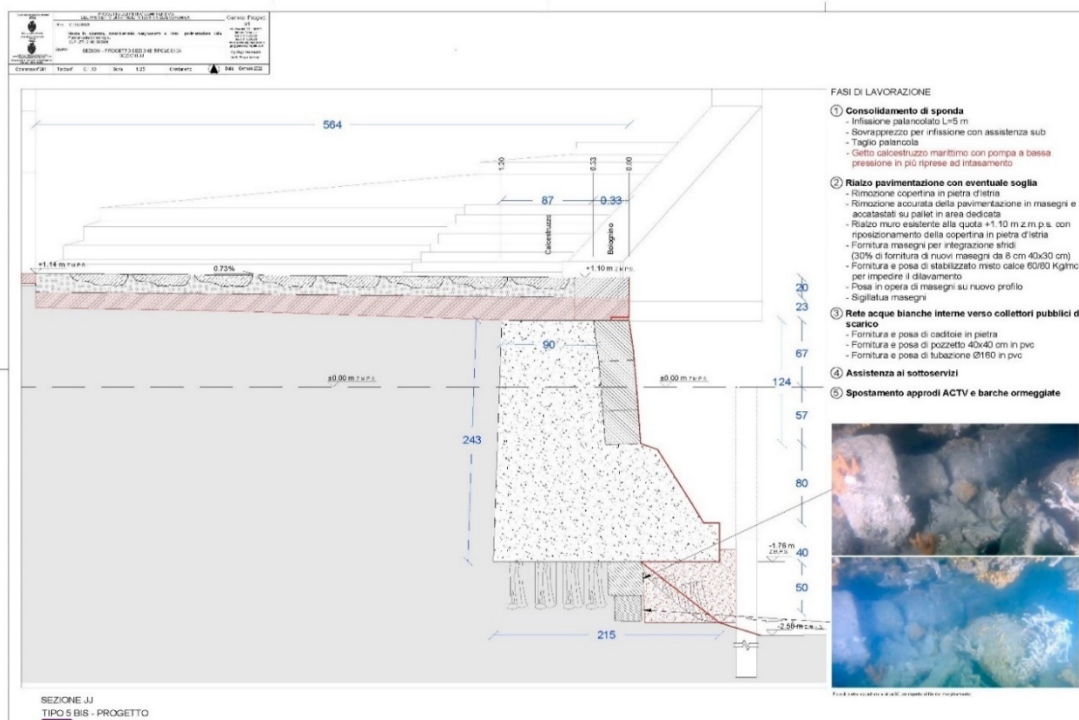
Sezione di progetto della fondamenta con interventi antiscalzamento
